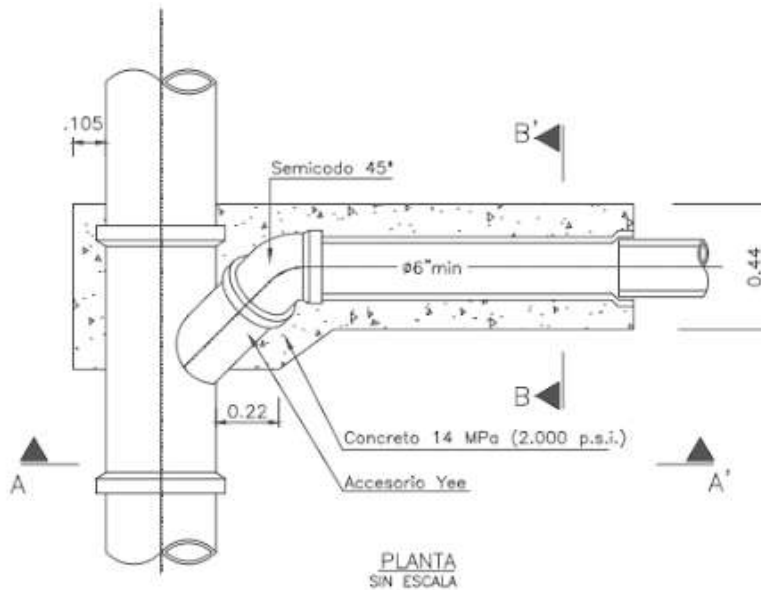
Esquema en planta conexión. Domiciliaria - Red principal alcantarillado.
